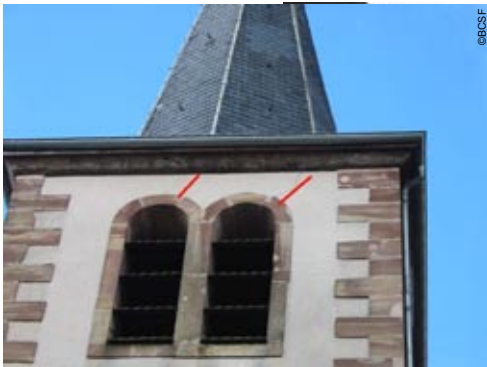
Roville-aux-chênes (dép.88) - Fissures sur ouverture en doubleaux.
